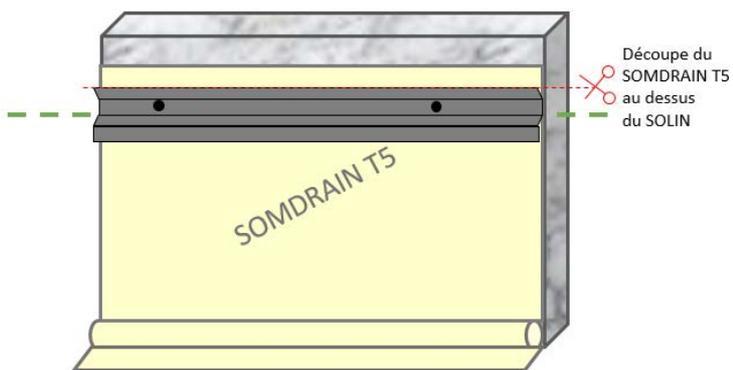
positionnement du solin et découpe du SOMDRAIN T5
